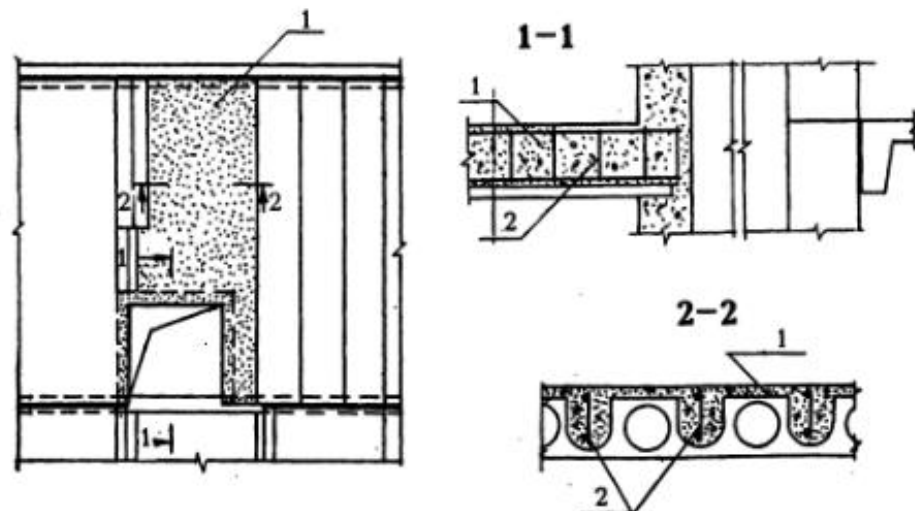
Устройство проема в перекрытии из многослойных настилов: 1 - бетон замоноличивания; 2 - арматурные каркасы
